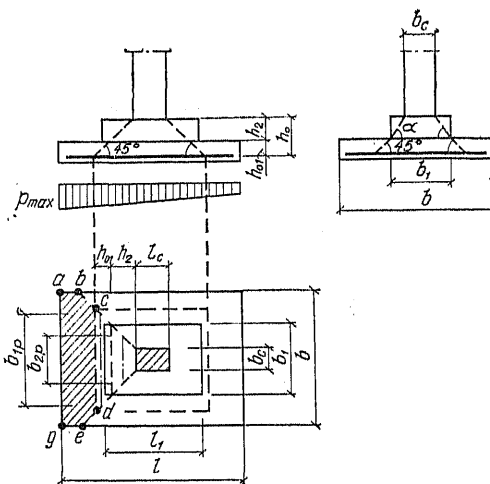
Схема образования пирамиды продавливания для прямоугольного фундамента
